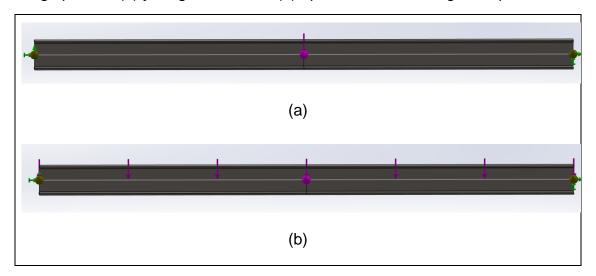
Vista lateral del perfil estructural cuadrado mostrando su longitud.
